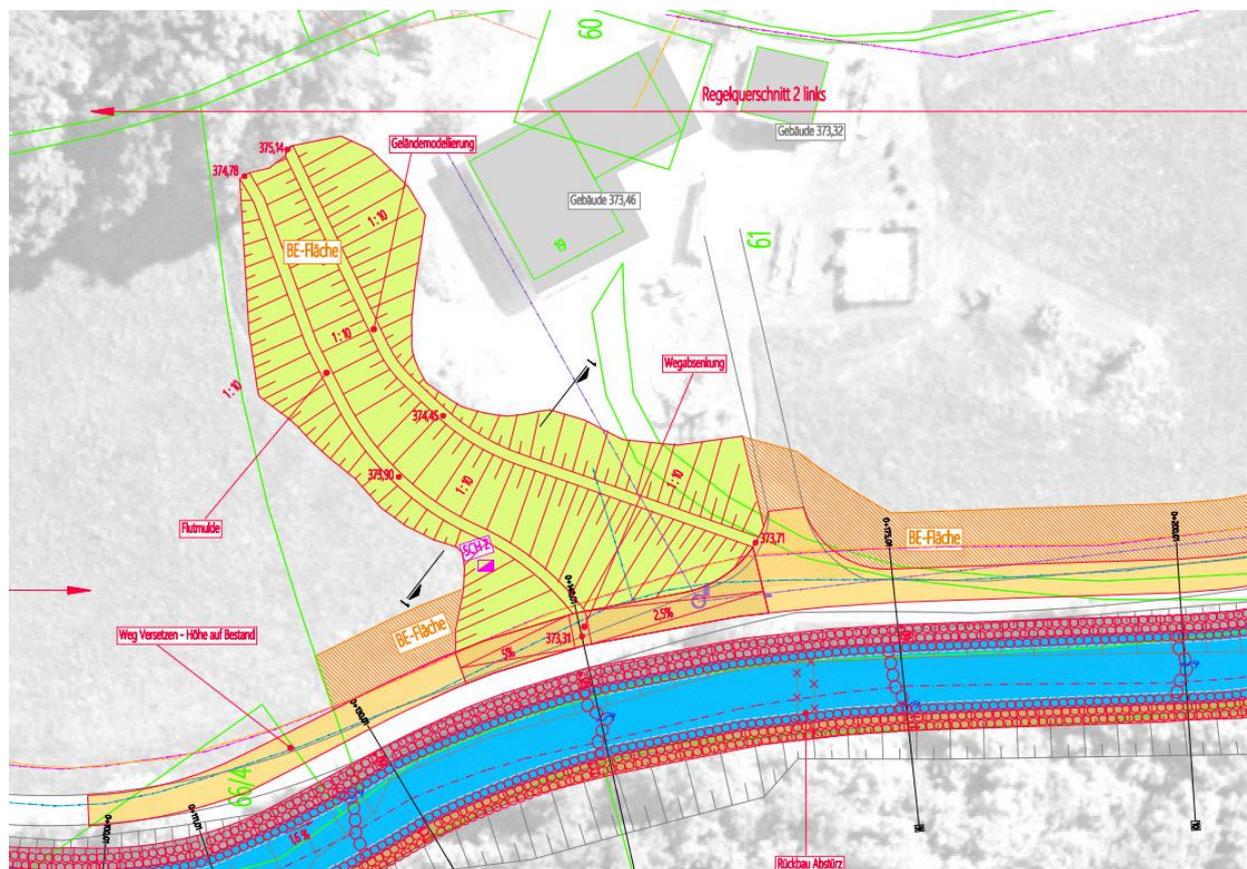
Auszug Lageplan Geländemodellierung Bereich Erlmühle
